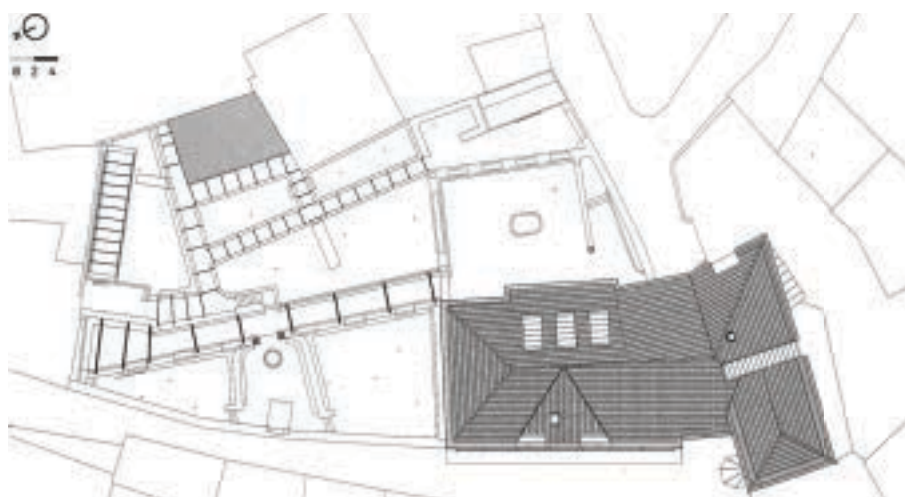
Planta de cobertura. (Ribeiro, 2013a, p. 127)
